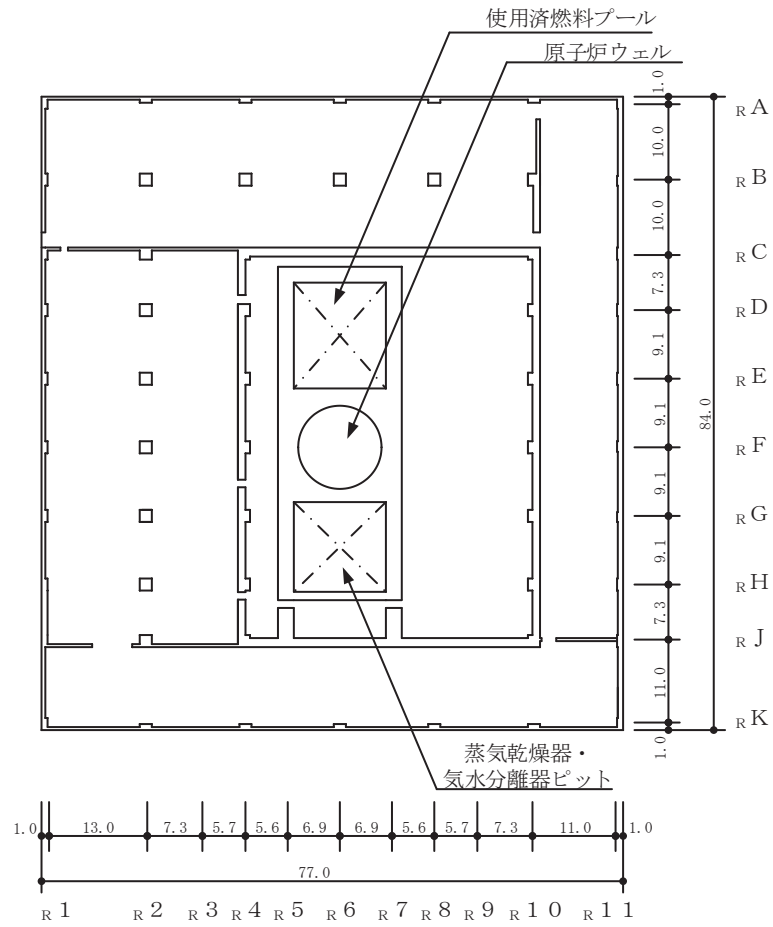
使用済燃料プールを含む原子炉建屋の概略平面図 (0.P. 33. 2m)
